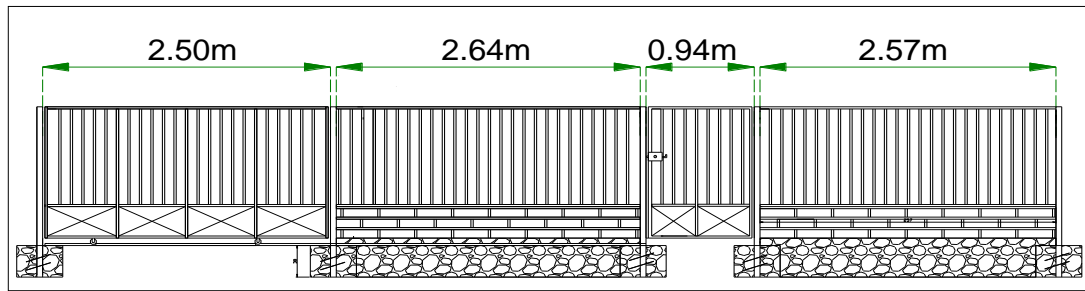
Detalles Largos Perfiles Horizontales Fuente: Propia
